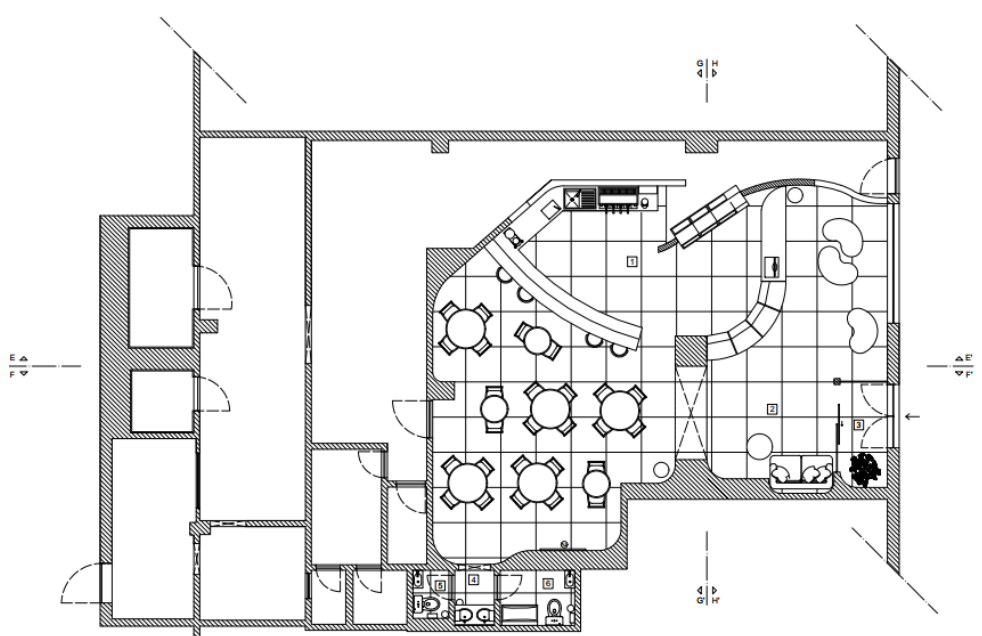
Planta de Apresentação. Fonte: Autora, 2025
